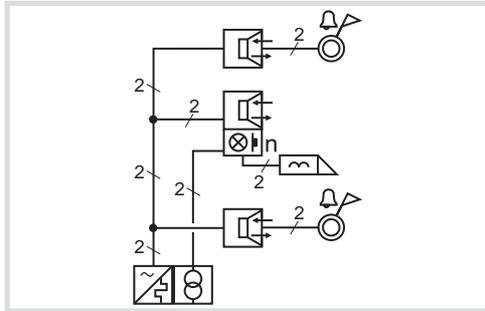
audio i2 – Collegamento di una stazione da porta sui piani
